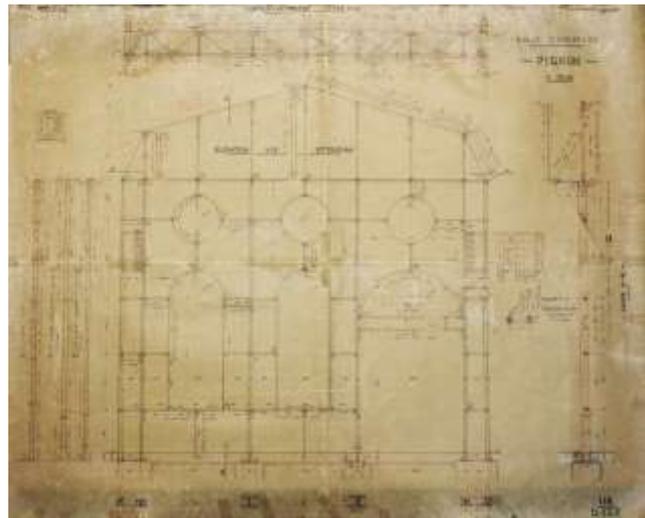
Elévation du pignon sur cour (AVV, 96.01, Fonds ACMV, Plans de la nouvelle halle de montage des turbines n°118/D115-127).
